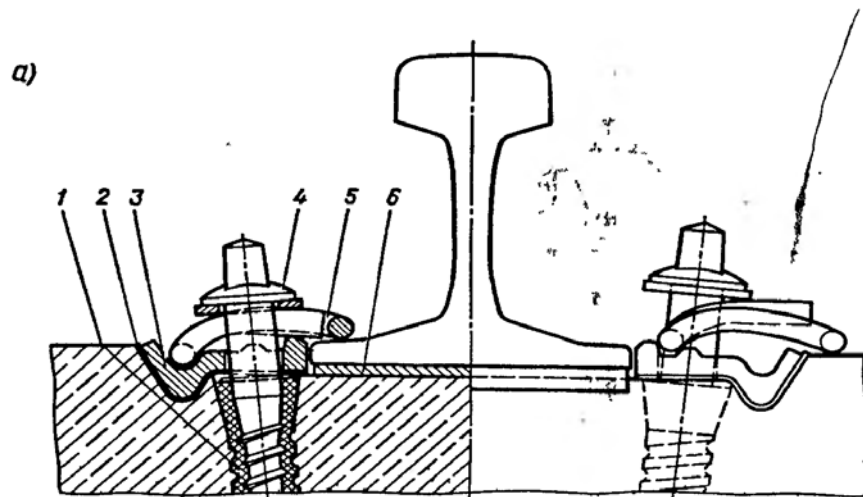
Бесподкладочное крепление WS8 для железобетонных шпал:
